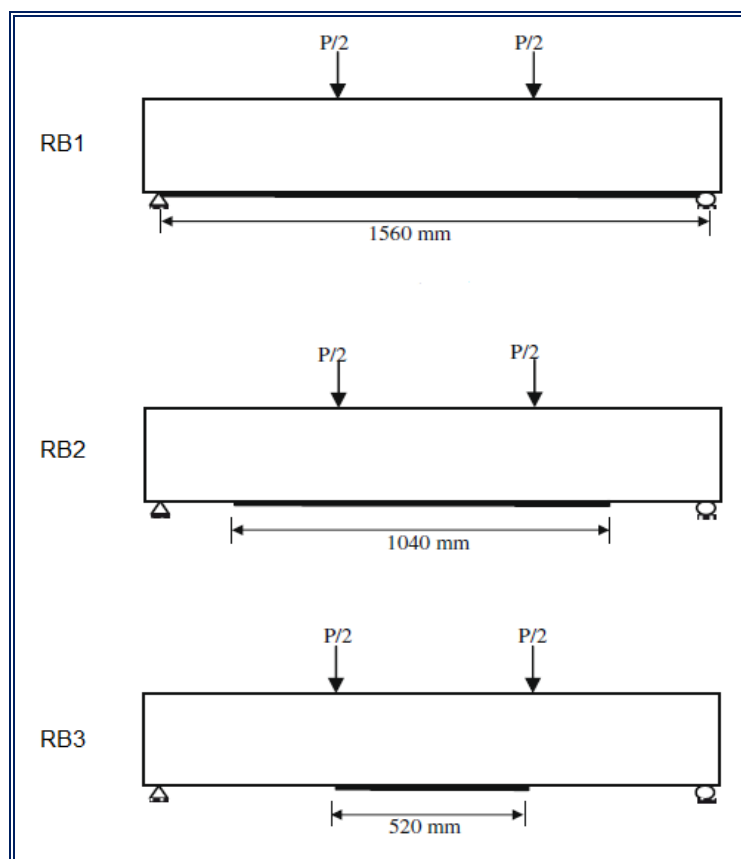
MODELOS DE VIGAS REFORÇADAS ENSAIADAS POR OBAIDAT (2007).
